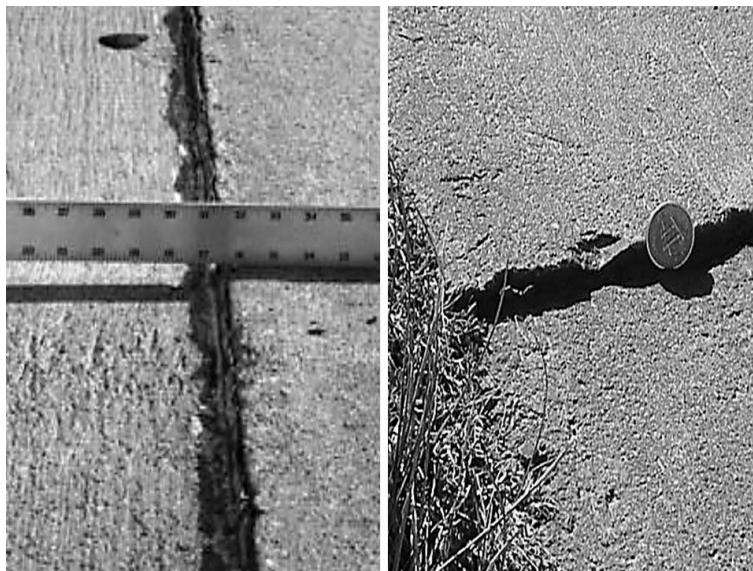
Escalonamiento en juntas y fisuras transversales
